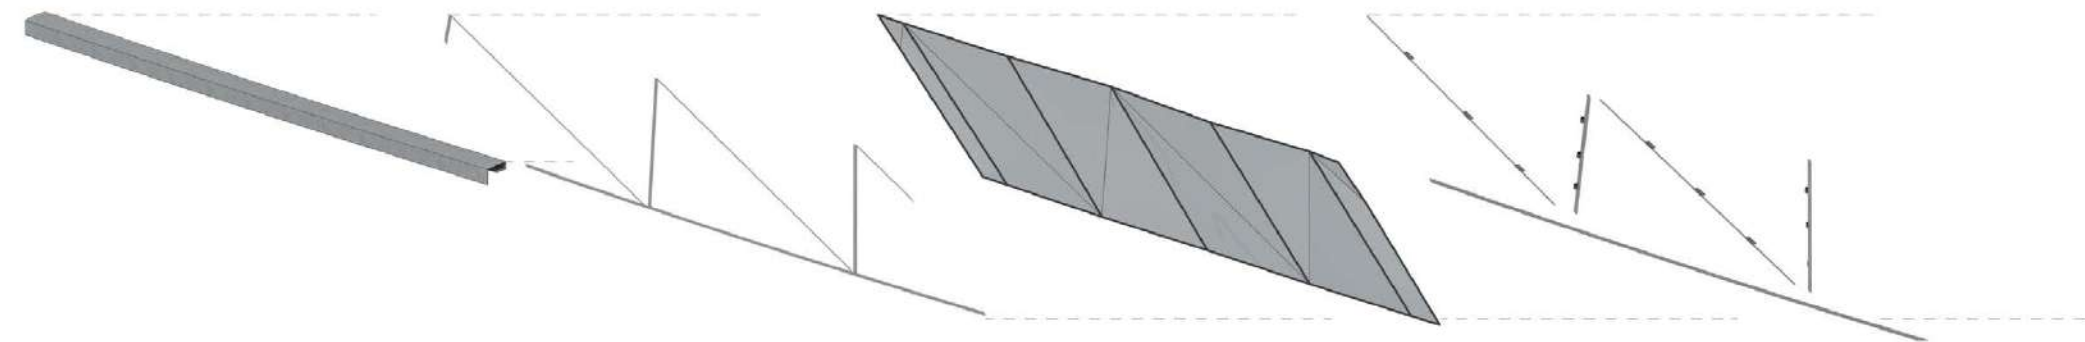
Drenaje campo de juego Fuente: Elaboración propia
